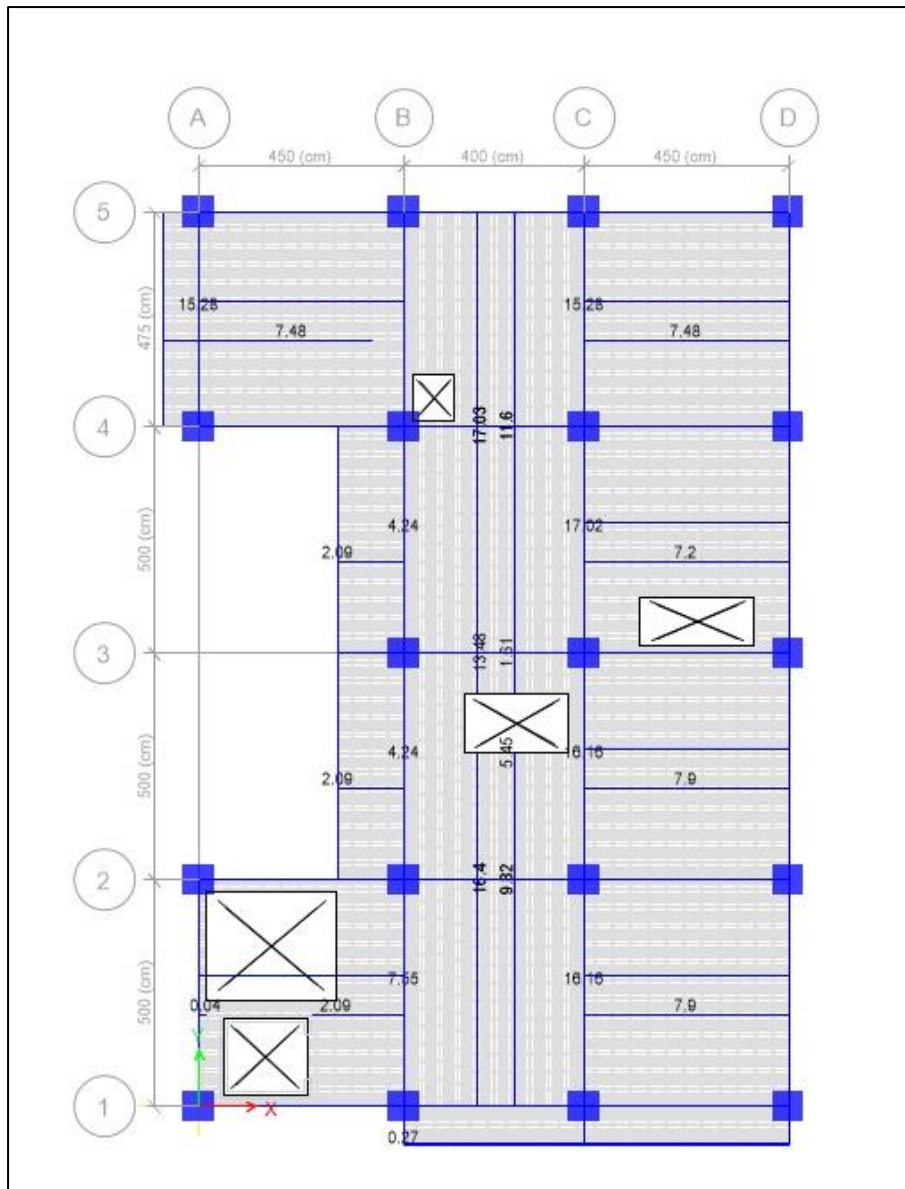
Cálculo de área de acero en losas aligeradas planta típica
